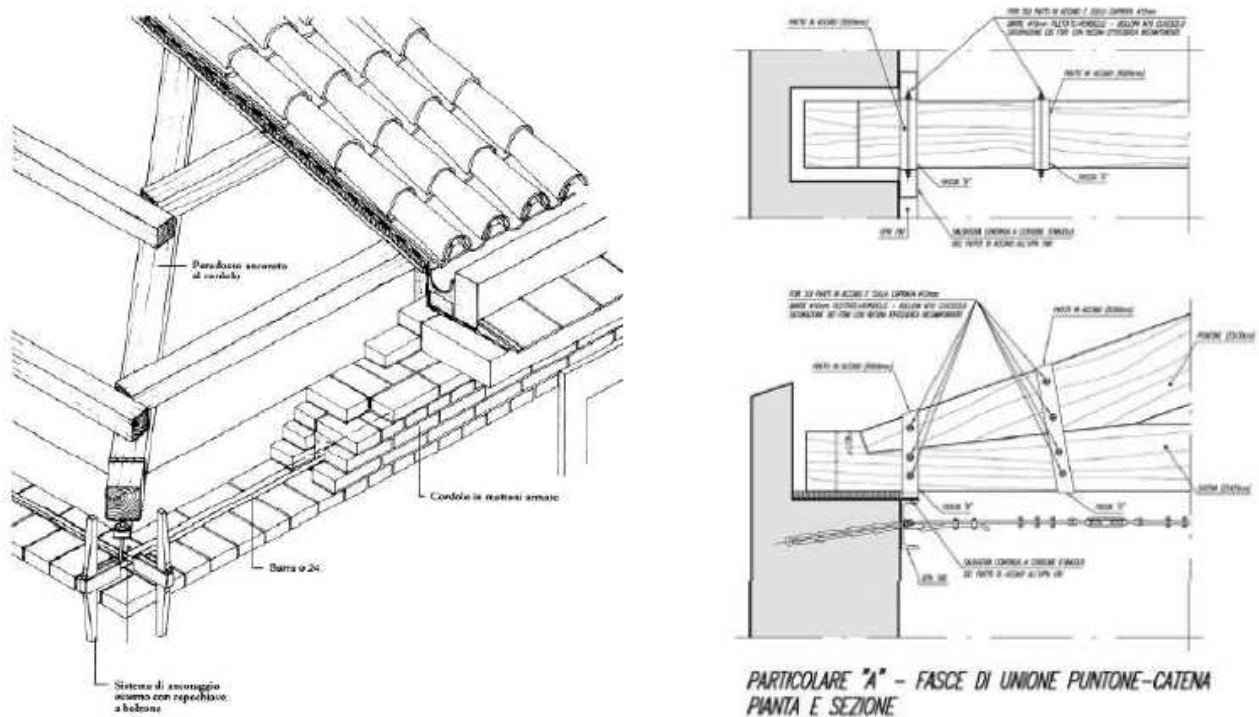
Ancoraggio in angolo di travi in legno alla muratura (sinistra) e particolare di "cravattatura" per trave a capriata (destra)
